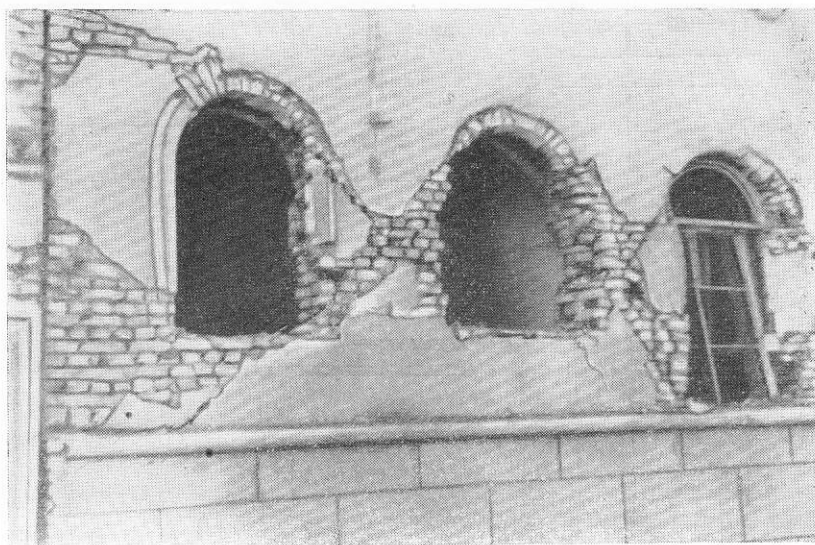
Повреждения узких простенков, нагруженных большой сосредоточенной нагрузкой
